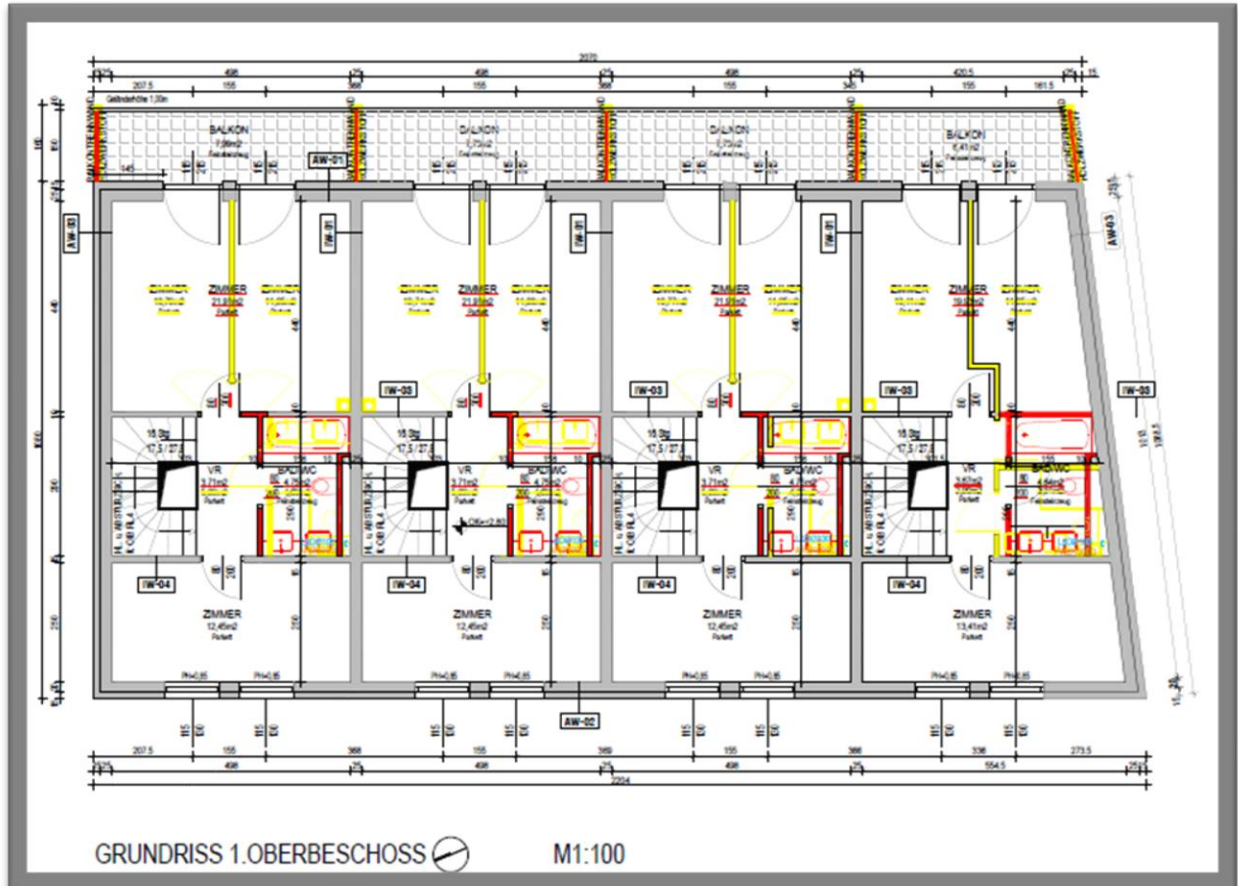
Grundriss 1. Obergeschoss
